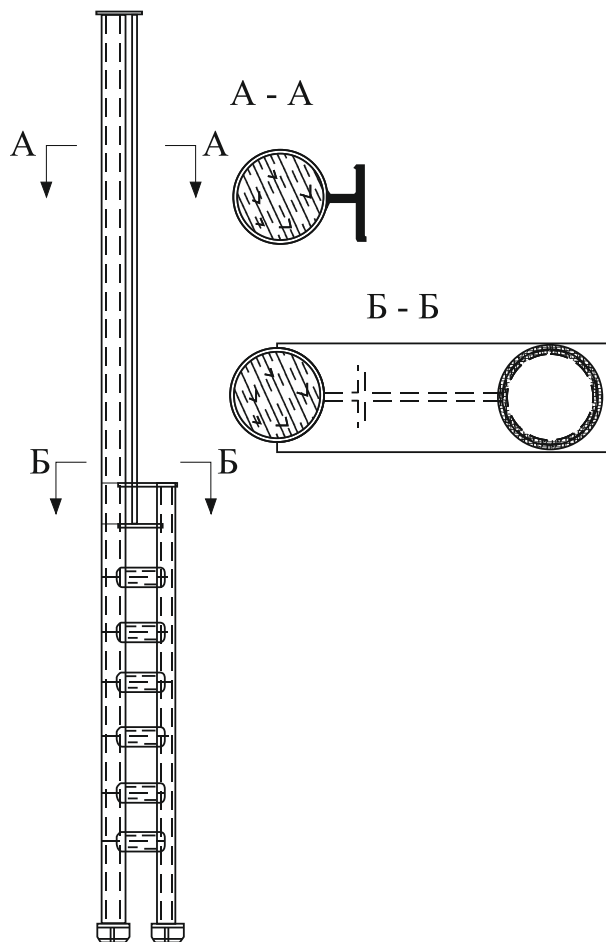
Трубобетонная колонна одноэтажного промышленного здания [5]
